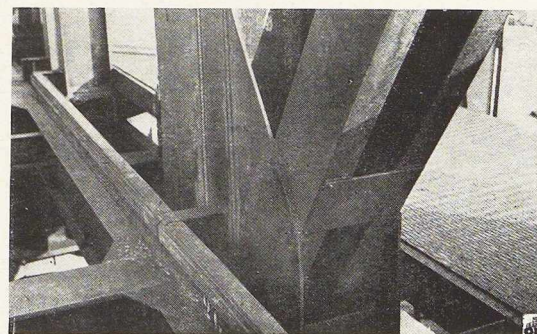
Détail d'un assemblage soudé (voir fig. 320).
